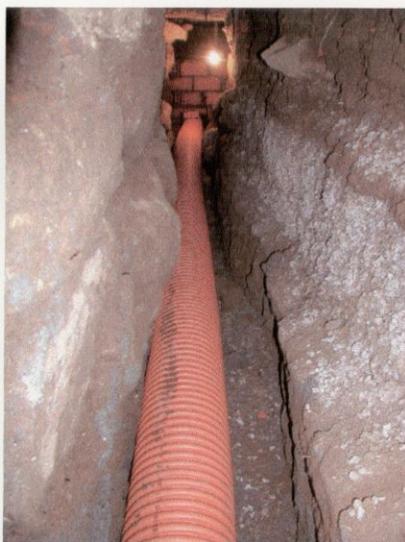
Sector SOA02/01. Detalle desde el interior de la zona excavada
